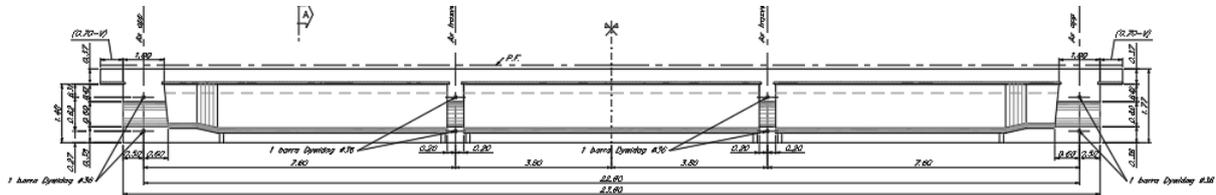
Ponte Frestola – Sezione longitudinale impalcato
